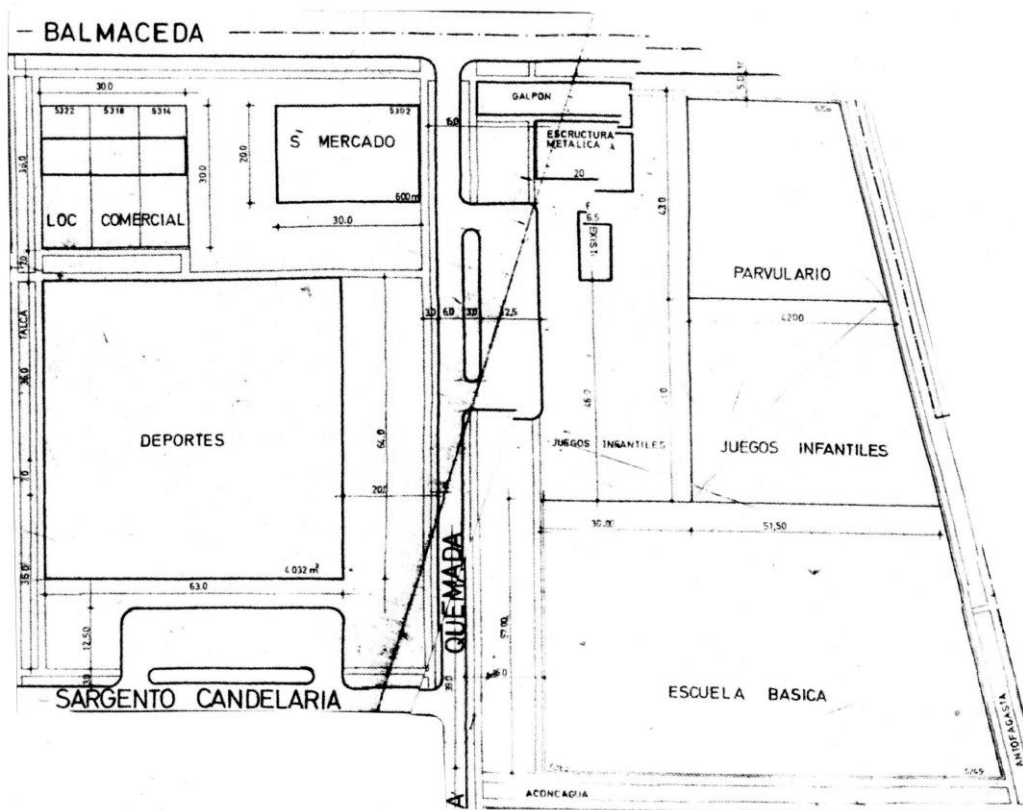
Extracto del Plano SDSN 1320 de octubre de 1973. Plano facilitado amablemente por Teresa Cordero.
